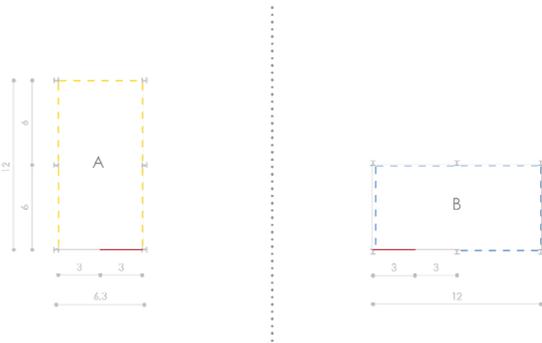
Esquema en planta S/E estrategia de módulo de circulación vertical
